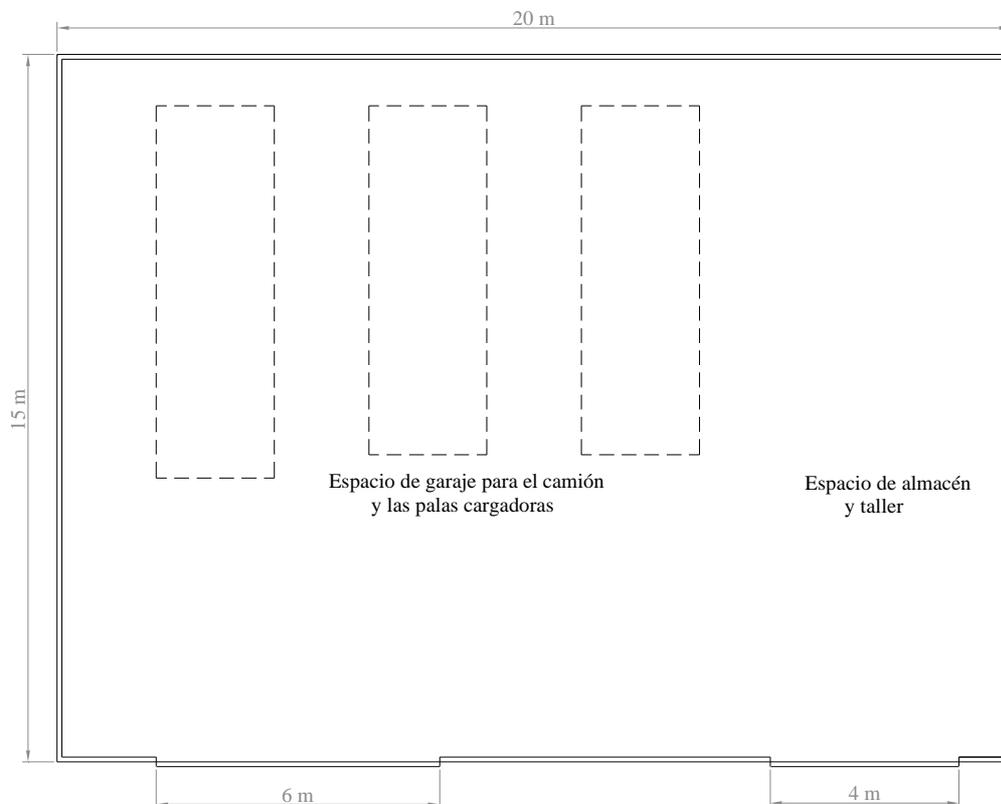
Planta de la nave taller/almacén/garaje.
